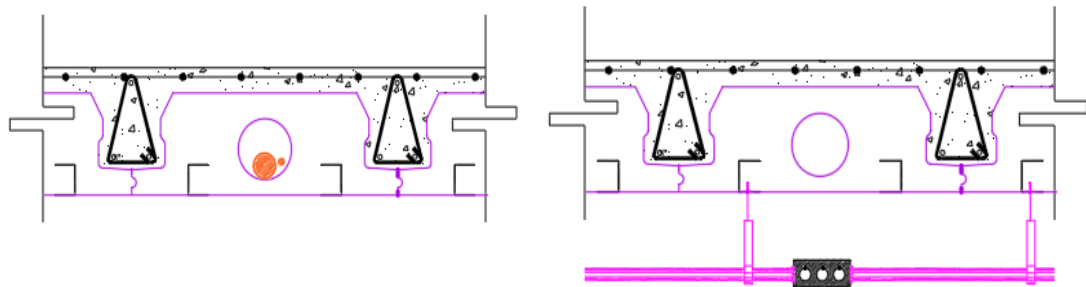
Detalle en corte transversal de paso de instalaciones: opción a) por los huecos del panel de poliestireno. Opción b) colgar instalaciones fijadas a postes metálicos del panel. (Área Técnica Novidesa, 2010)
